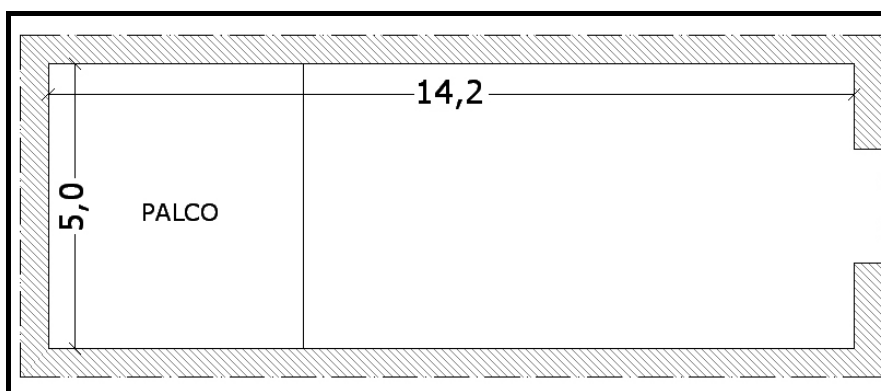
Planta do Bar-Concerto do Plano B
